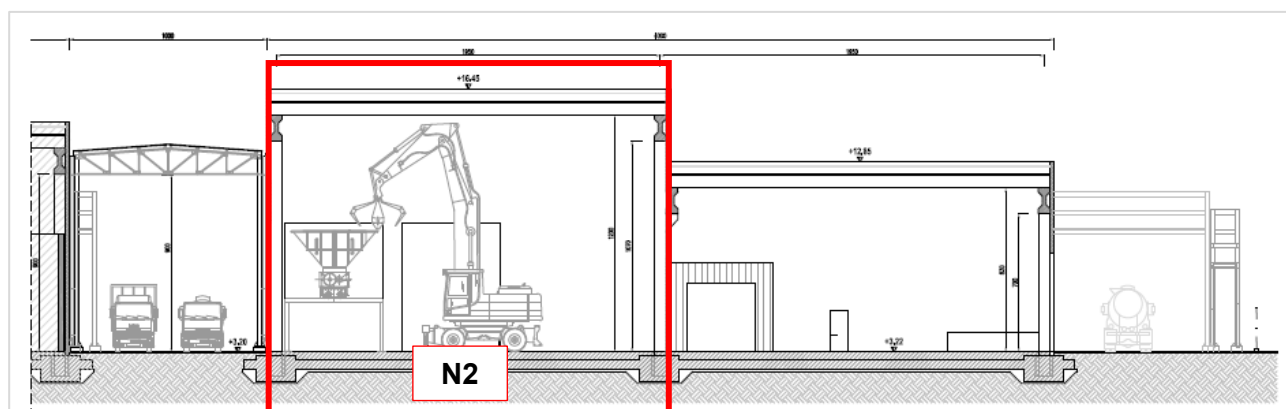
Sezione A-A (stralcio elaborato CO 05 RA VA 01 D1 PL 59.00 - N1-N2 PROSPETTI E SEZIONI)
